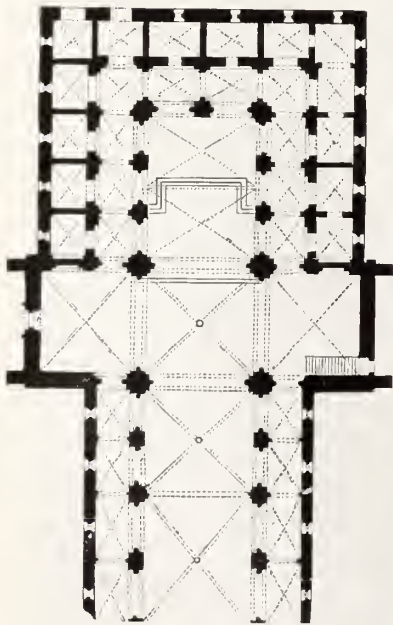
Kirche zu Riddagshausen. Grundriß.
